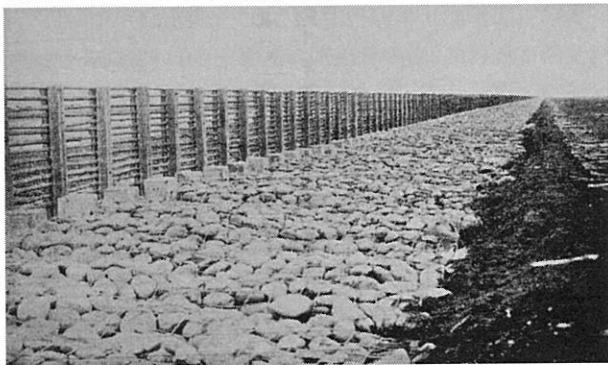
下淡水溪堤防の鉄筋コンクリート造の基礎部分、(『台湾に於ける鉄筋コンクリート構造物寫真帖』、1914)
